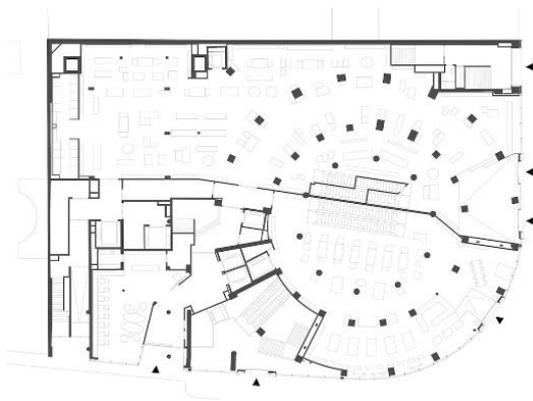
Grundriss Erdgeschoss 2015,
